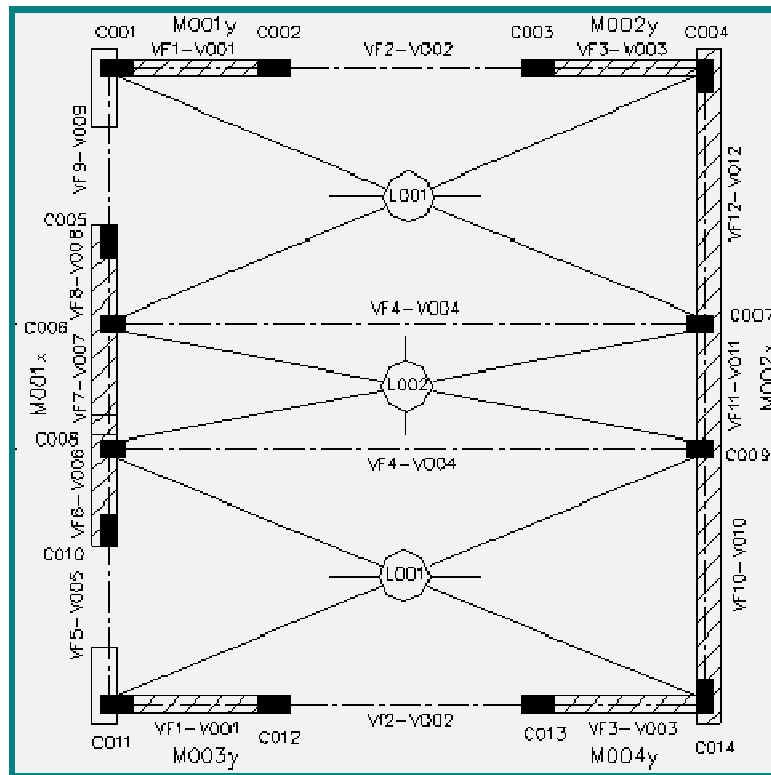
Planta de estructura tipo del edificio con aislamiento sísmico
